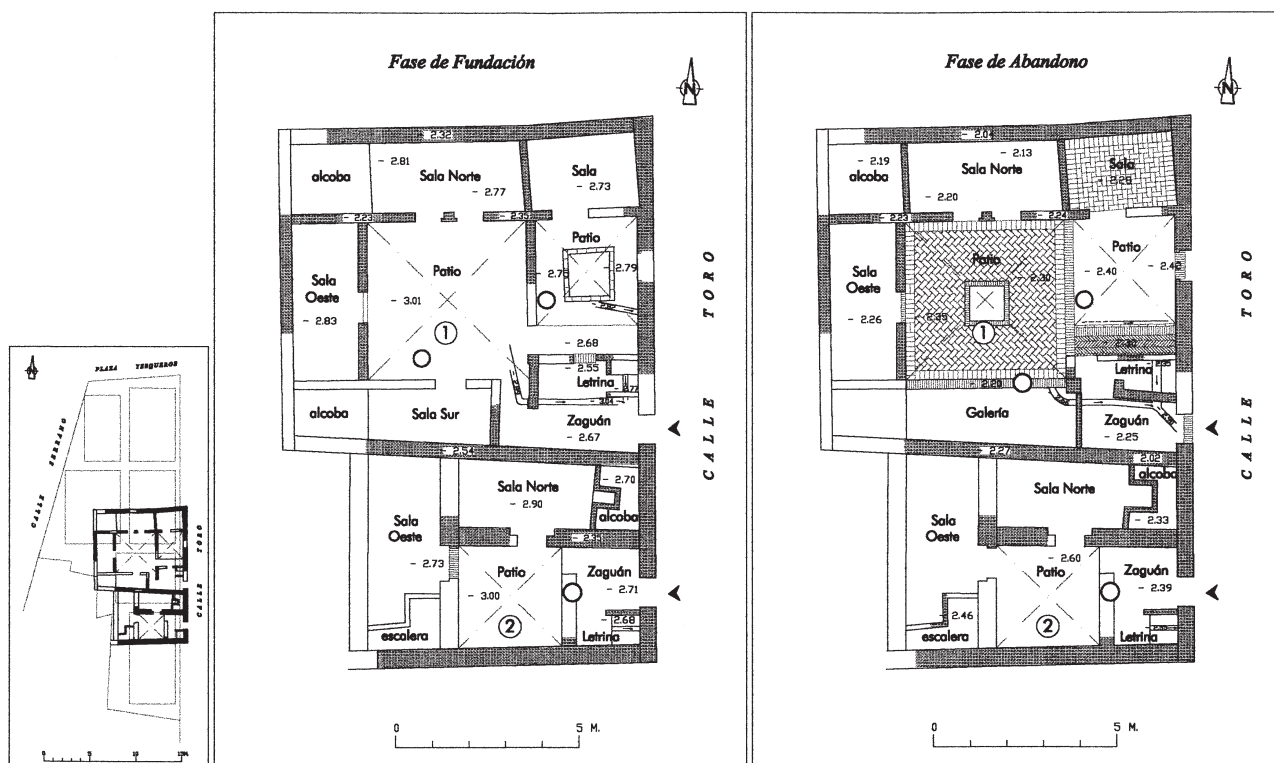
Planta restituida de las viviendas nº 1 y 2 (nivel III, primera mitad del siglo XIII).
